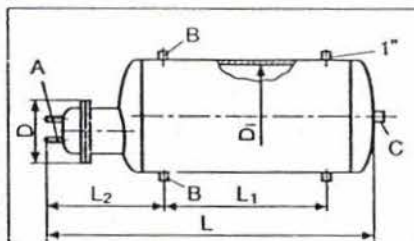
Boiler orizontal cu gât, (dimensiuni tab. 2.9.1).
